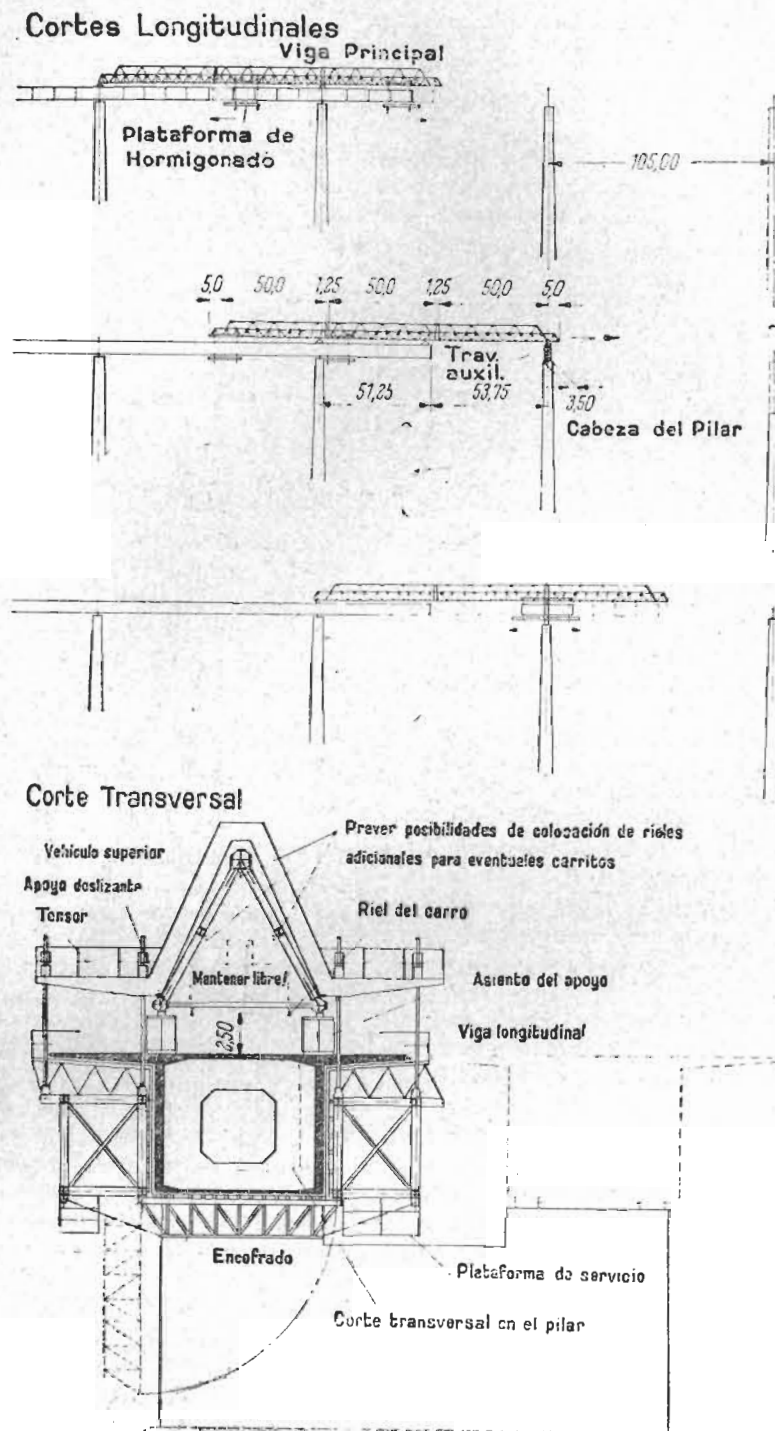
Descripción esquemática del proceso constructivo en el puente Eiserfeld.
